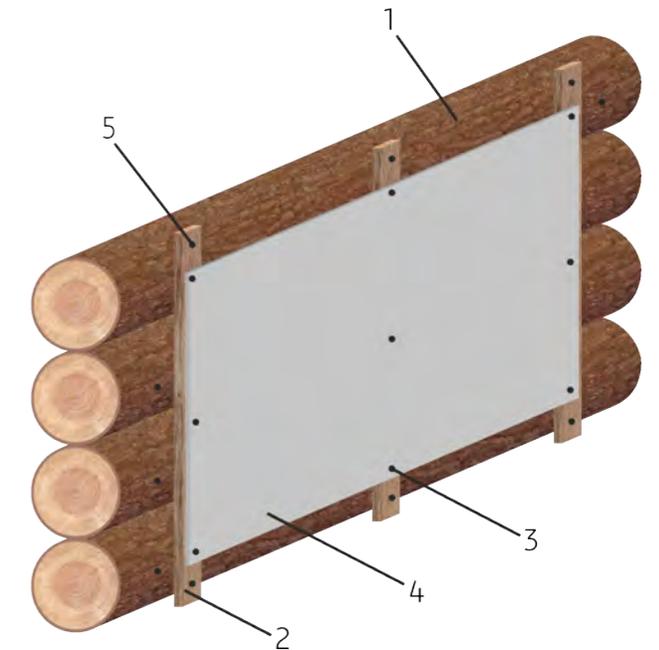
Фасад деревянного здания из плоских хризотилцементных листов
